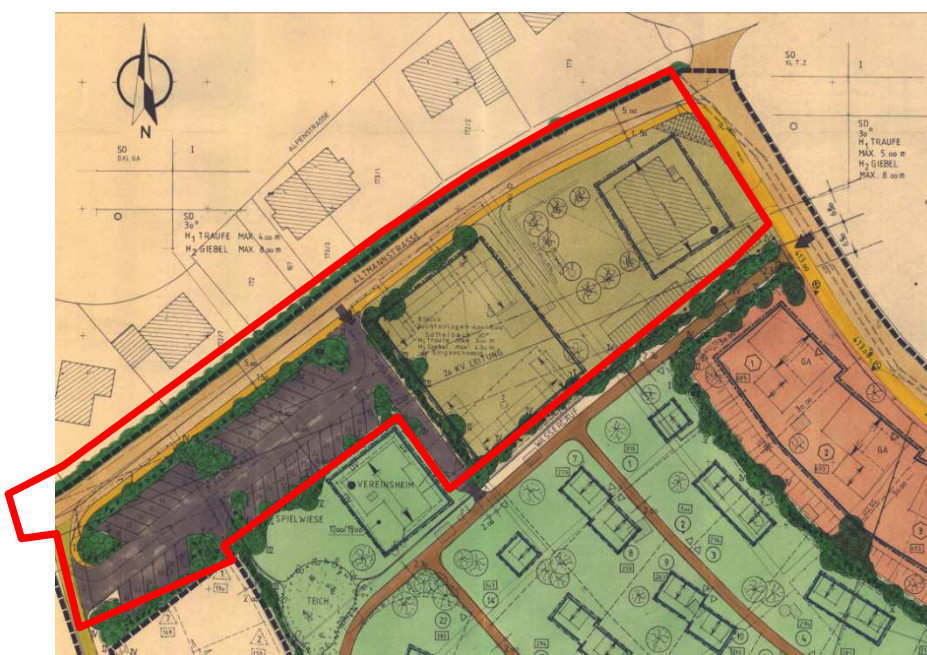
Ausschnitt aus dem rechtsgültigen Bebauungsplan „Kleingartengelände an der Pfänderstraße“ (1986), unmaßstäblich
